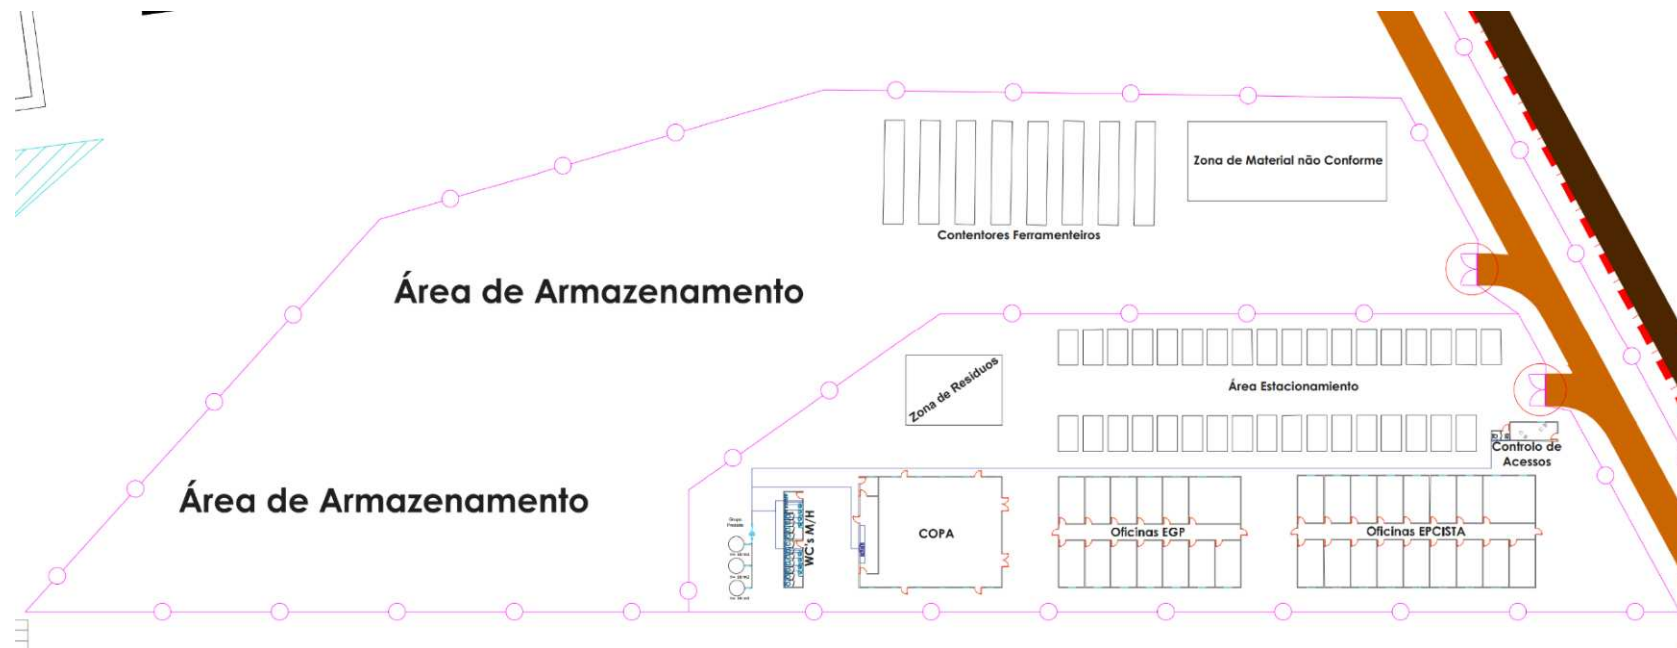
Plano do estaleiro a ser utilizado durante a fase de construção da CFCV
